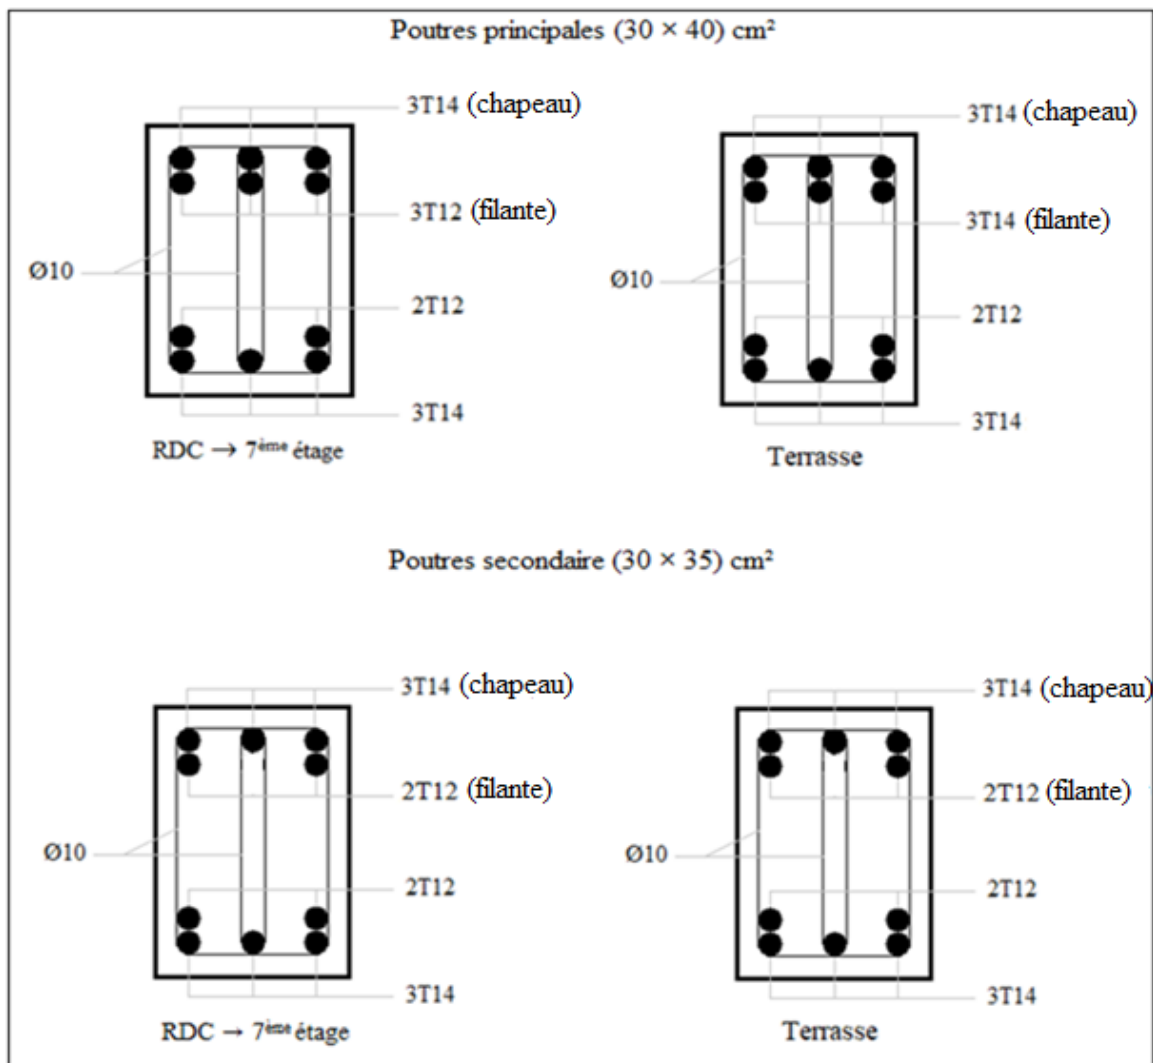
Dessin de ferrailage des sections des poutres principales et secondaires
